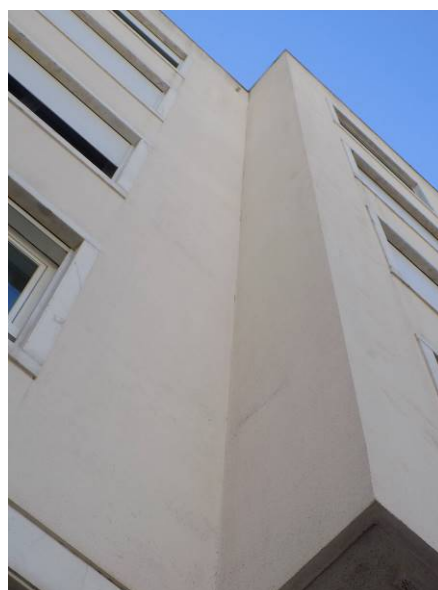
Idem. Idem. Fissuras com orientação horizontal, de abertura reduzida, no revestimento da parede de fachada em zona corrente de alvenaria de tijolo.
